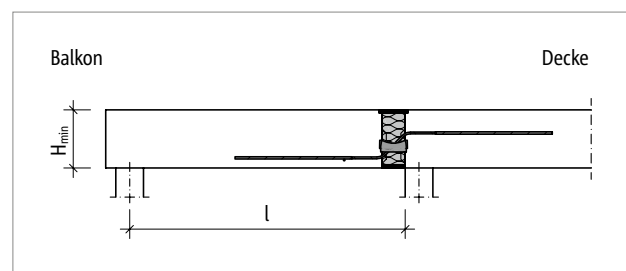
Schöck Isokorb® T Typ QL-V2 bis V6: Statisches System
